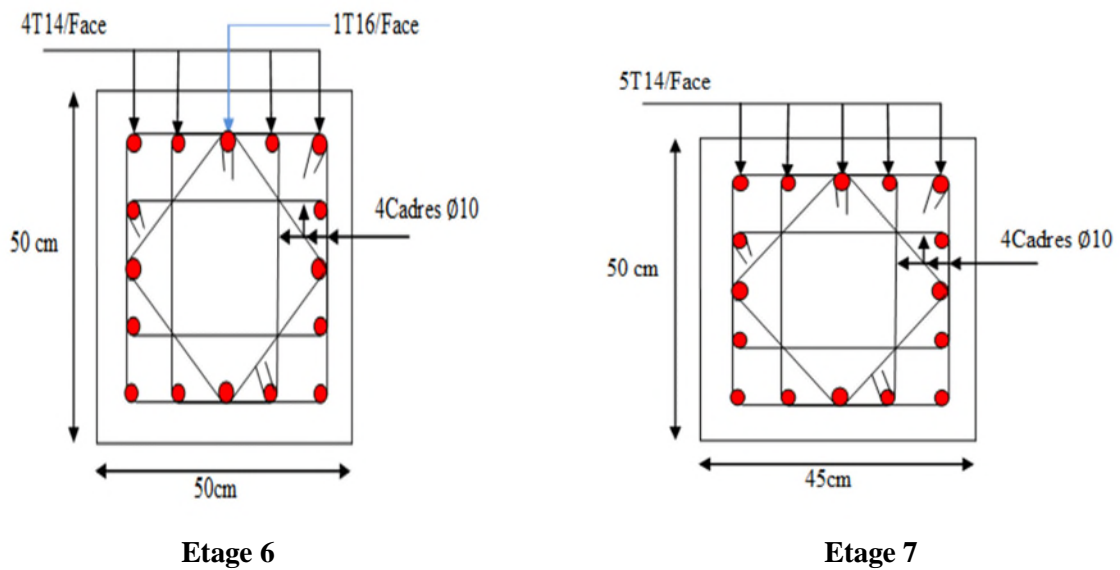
Schéma de ferrailage des poteaux des étages 6 et 7
